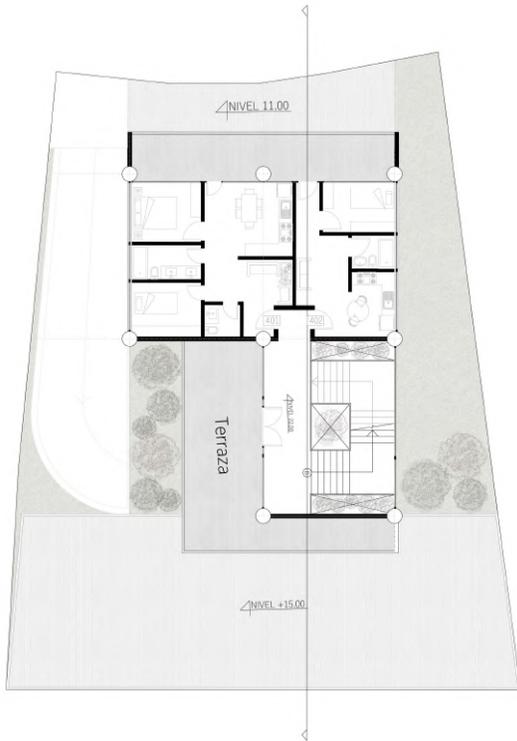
Tercera Planta Nivel 22.00 Vivienda multifamiliar. Elaboración Propia
